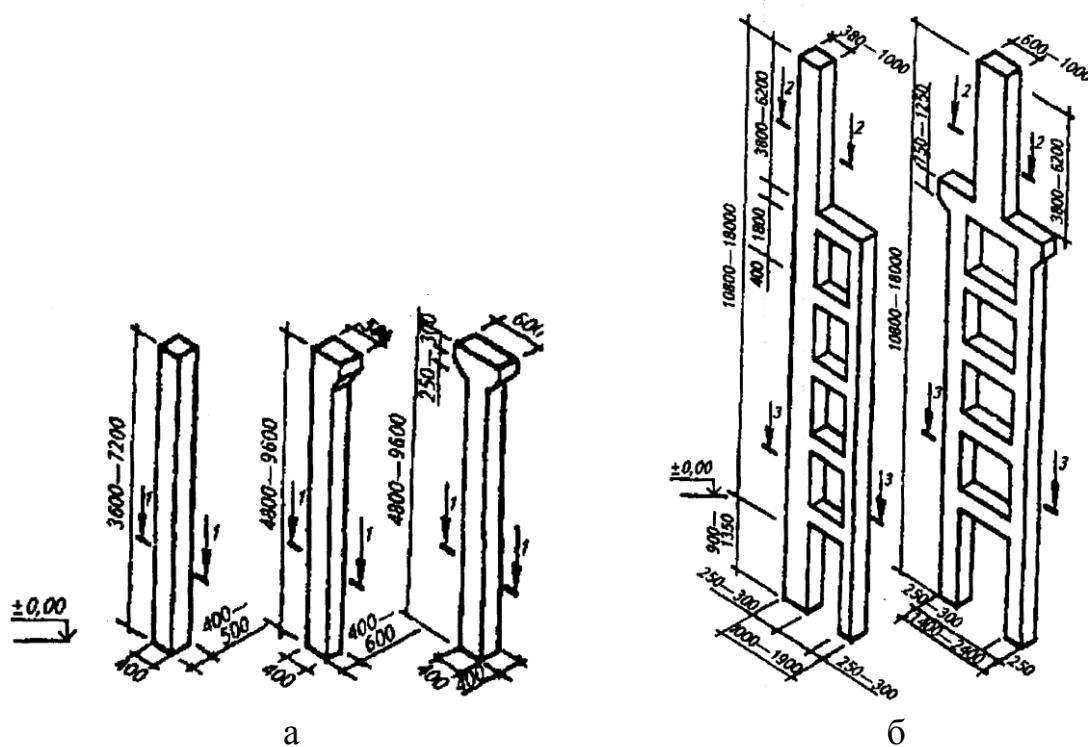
Основные типы железобетонных колонн для одноэтажных зданий:
